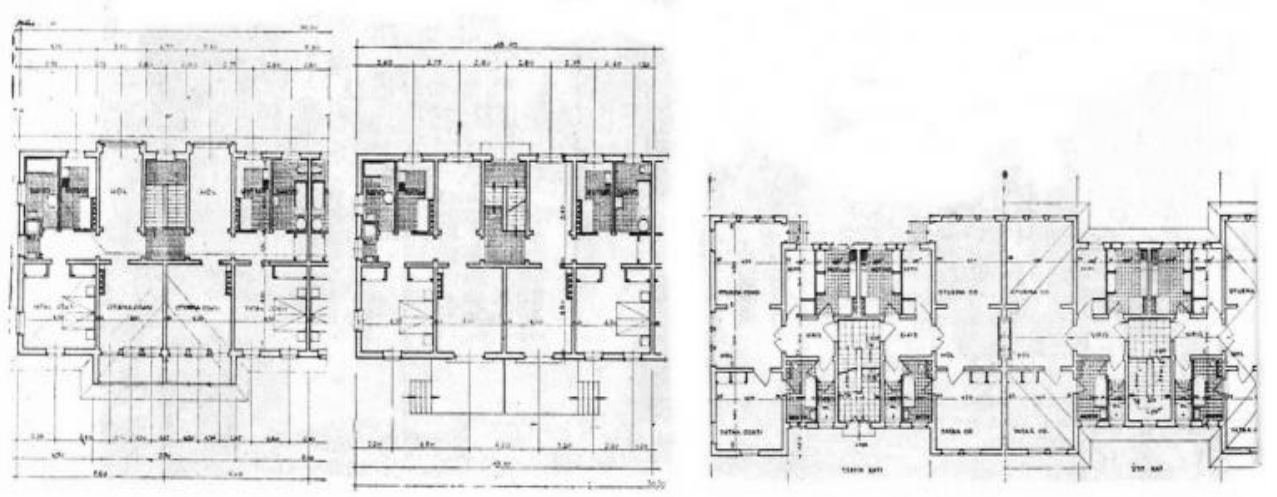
Saraçoğlu Mahallesi'ndeki konutlardan bir görünüm
